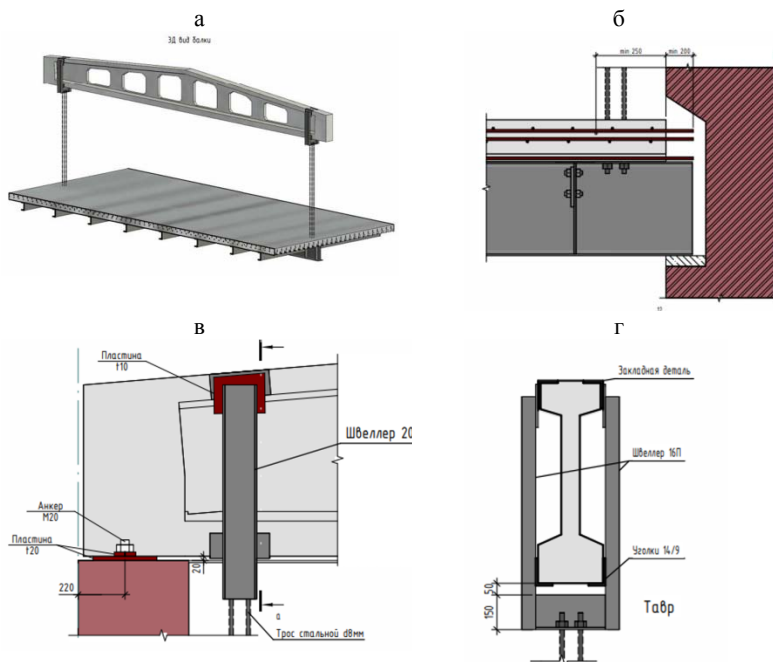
Конструкция нового перекрытия: а – общий вид, б – узел анкеровки перекрытия в стену, в, г- узел подвеса к балке перекрытия
